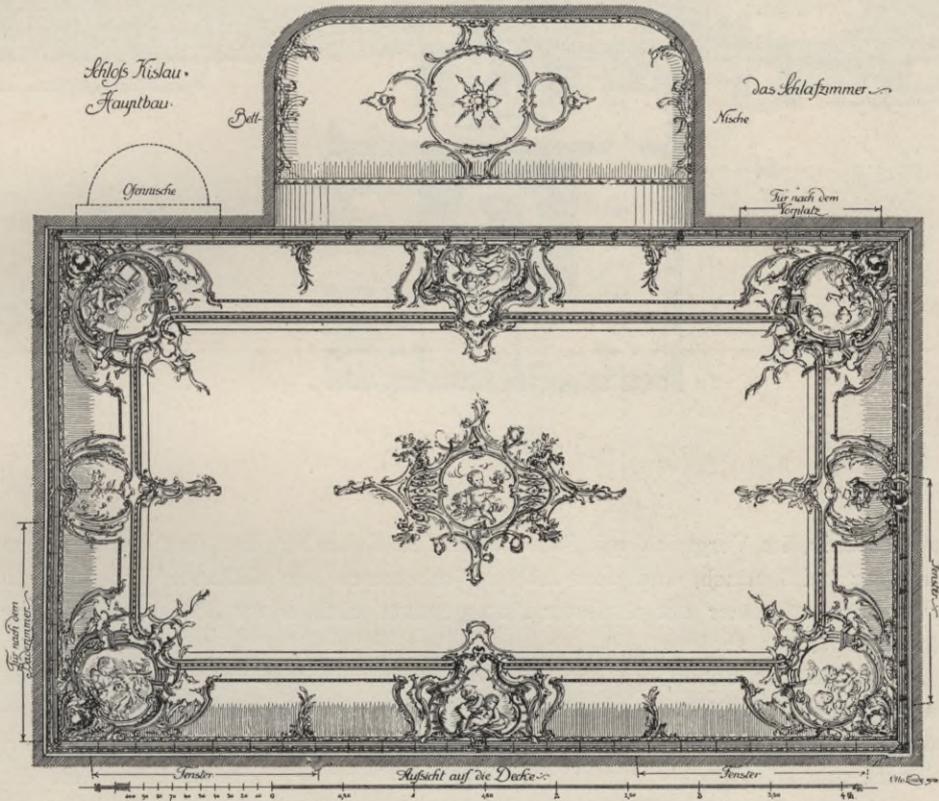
Decke im Schlafzimmer des Hauptschloßbaues zu Kisslau.
